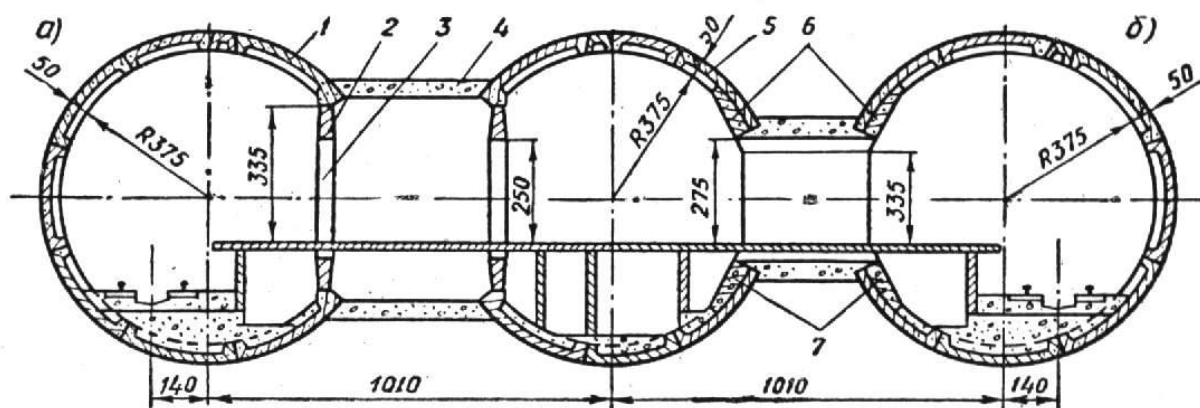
Пилонные станции с обделкой из сборного железобетона:
